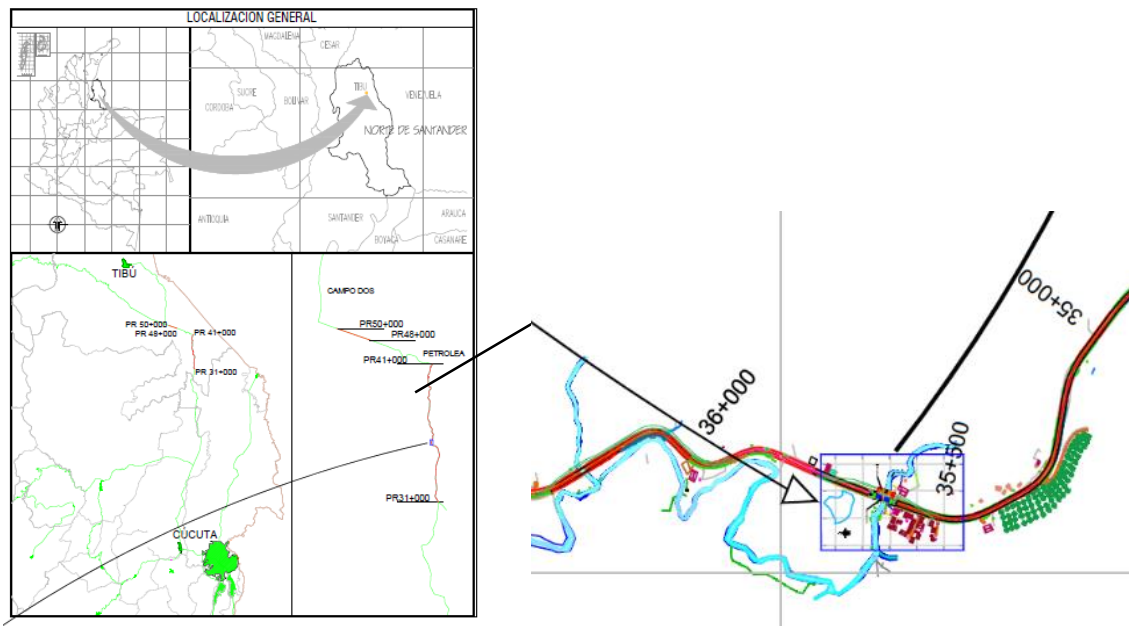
Planta general de localización de proyecto Tramo vial K35 + 480 – K35 + 710 Puente 4, Vía Astilleros – Tibú, en el departamento de Norte de Santander.
